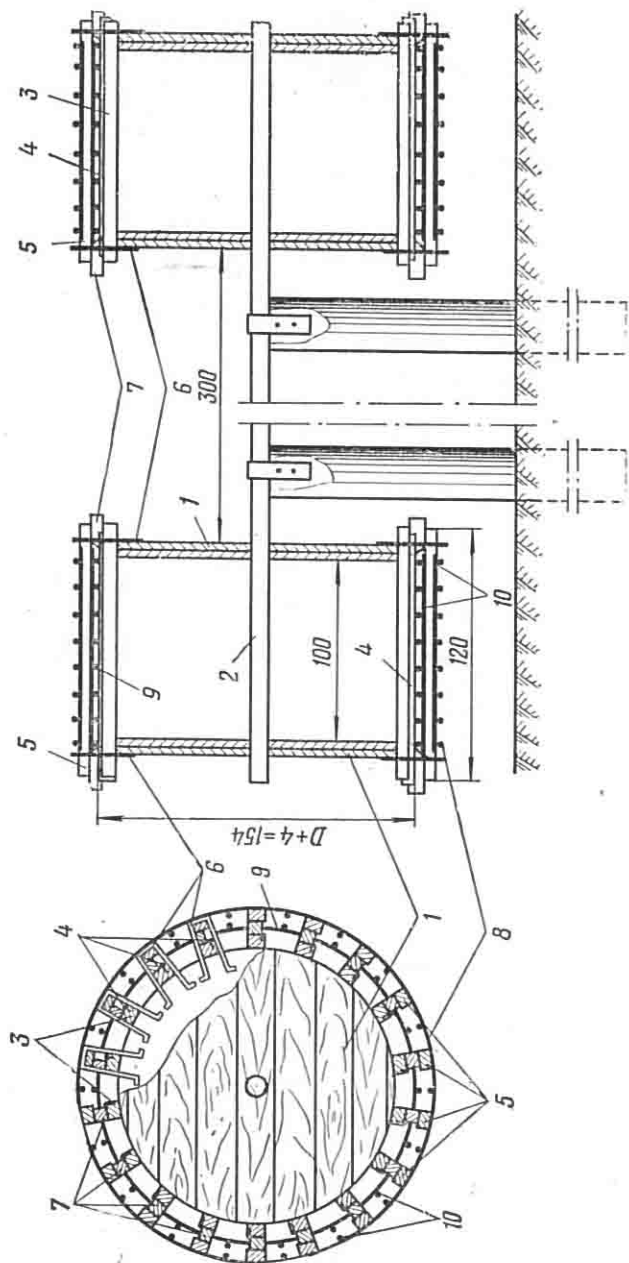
Барабан для изготовления арматурных каркасов круглых звеньев трубы диаметром 1,5 м:
